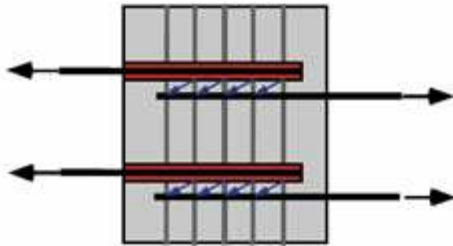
Nachträglicher Bewehrungsanschluss mit Lastweiterleitung über Anschlussbewehrung (Spieth (2002))
